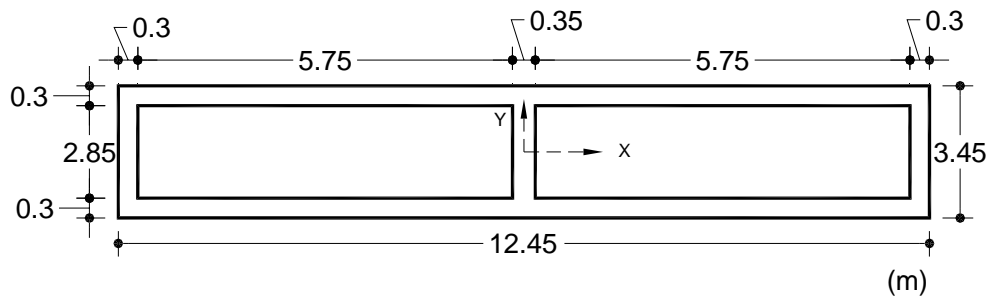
Sección 3 de la columna 10. (No. 10)
